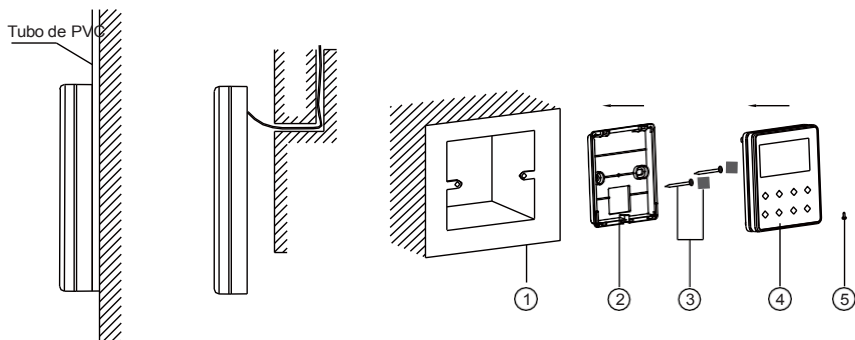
Acessórios para a instalação do controlo remoto com fios Tabela 3
